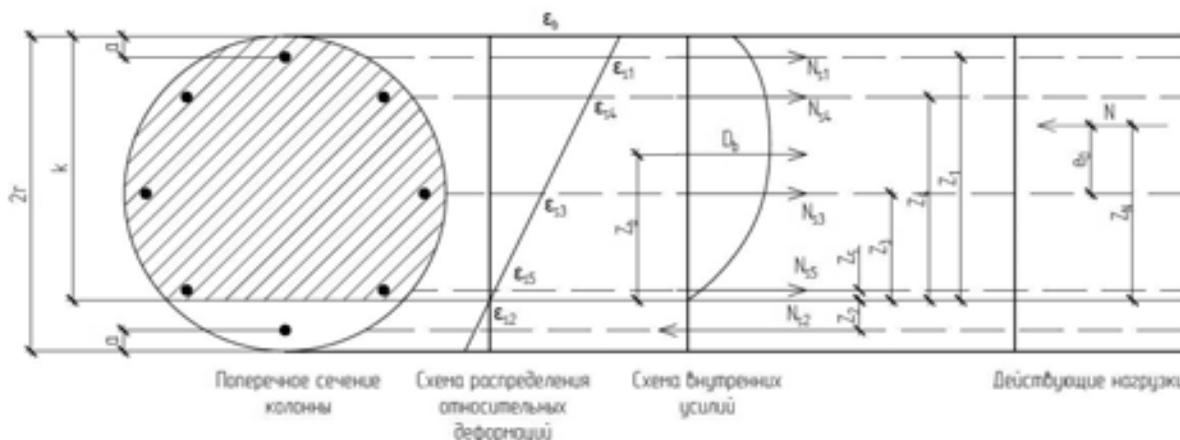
Схема расчетной модели внецентренно сжатого железобетонного элемента
